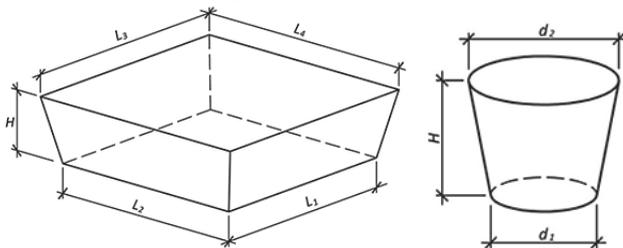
Схема прямоугольного и круглого котлована с откосами
